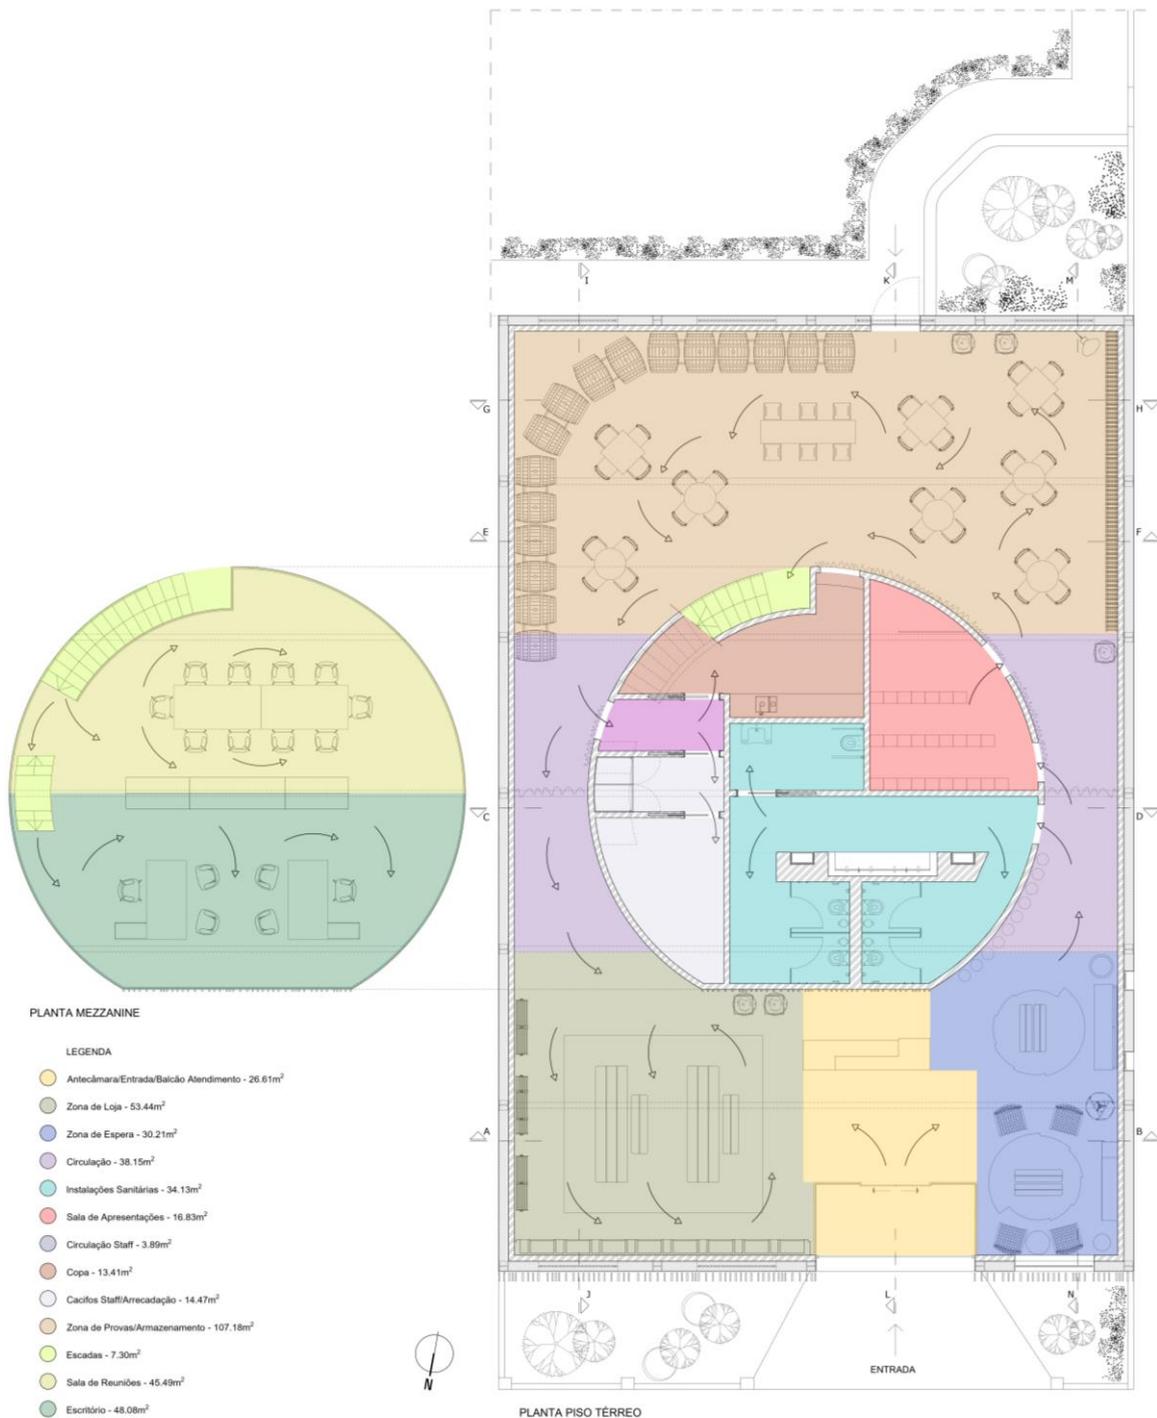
Desenho Técnico - Planta de Circulação e Zoneamento. Fonte: (Autor)
